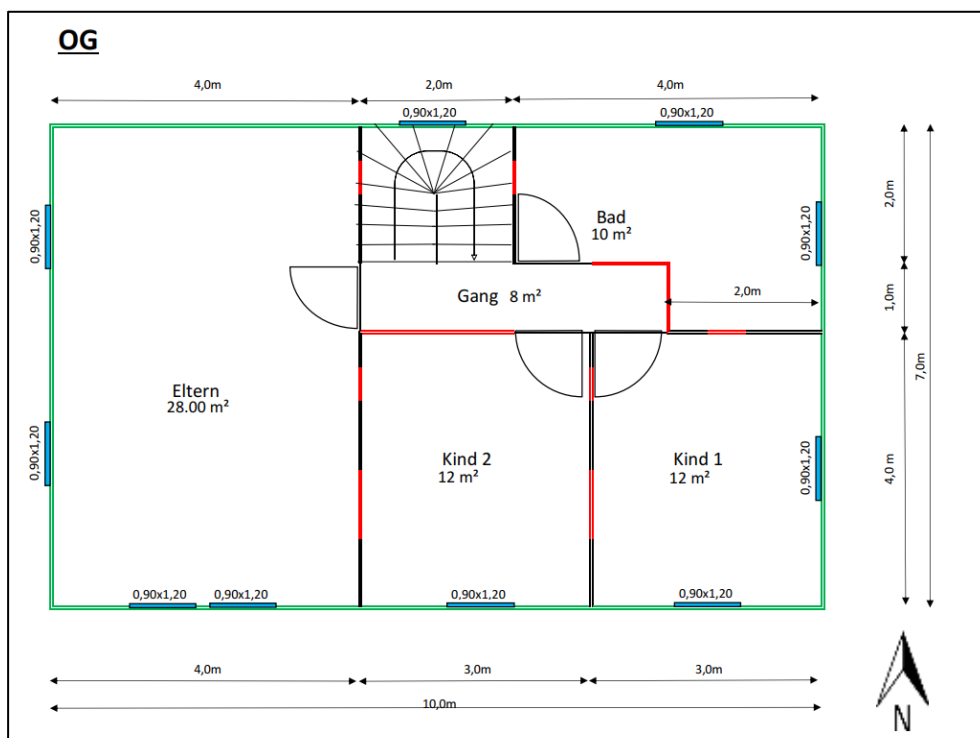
Grundriss Referenzgebäude, Obergeschoss (Schett 2020)
